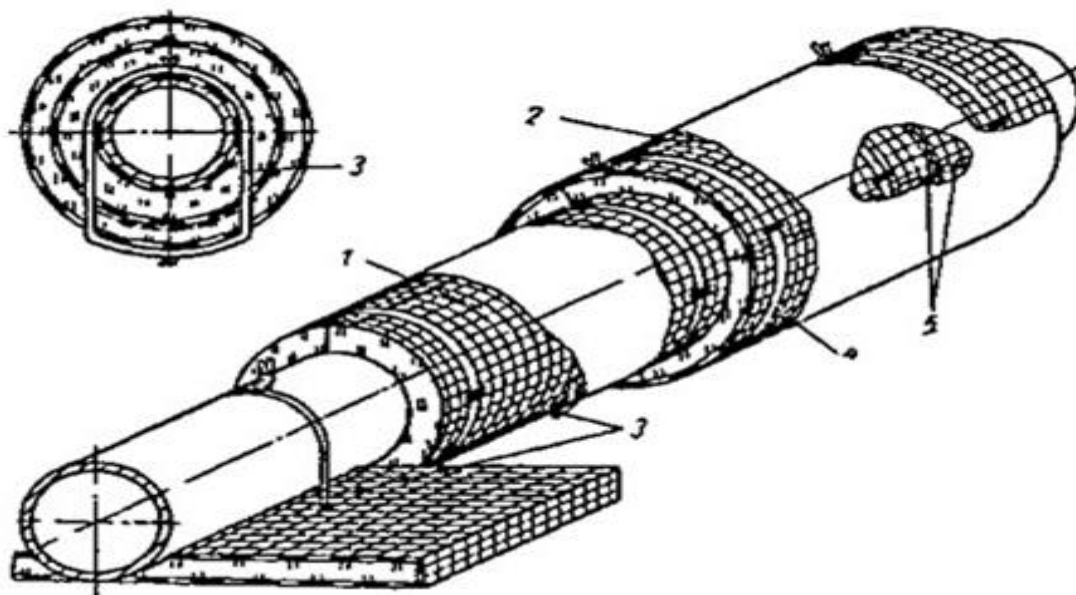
Тепловая изоляция трубопроводов минераловатными матами на подвесах:
